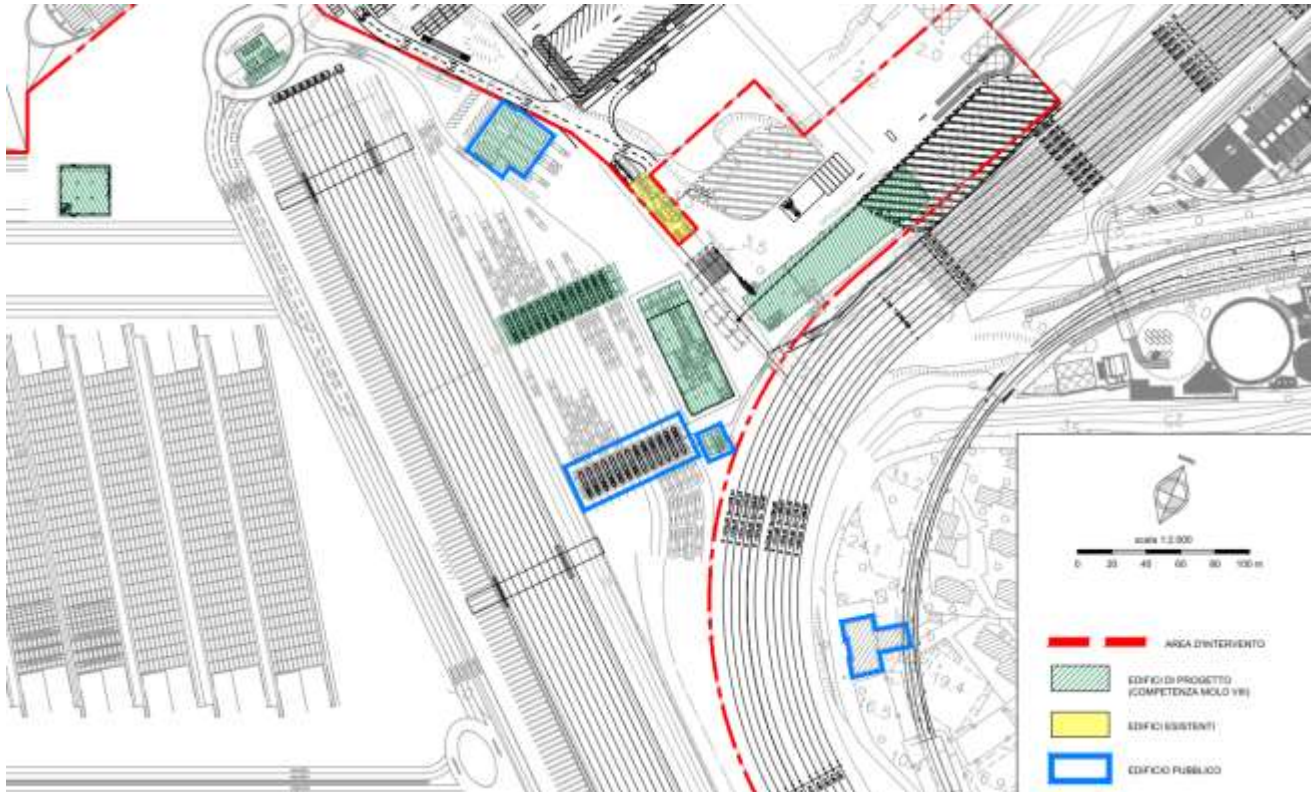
planimetria inquadramento edifici- identificati con perimetro blu
